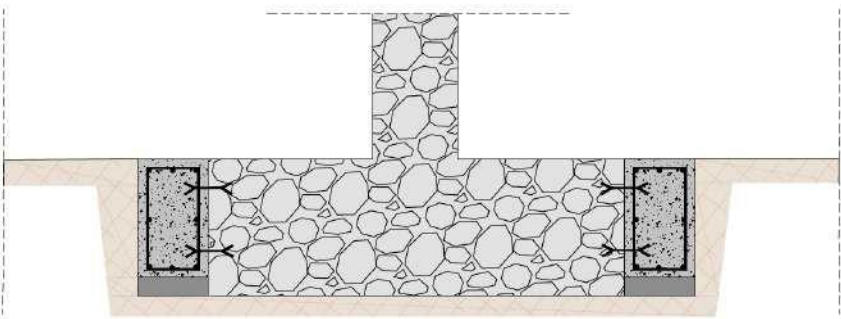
Sección zapata aislada. Refuerzo Tipo 1. Fuente propia
